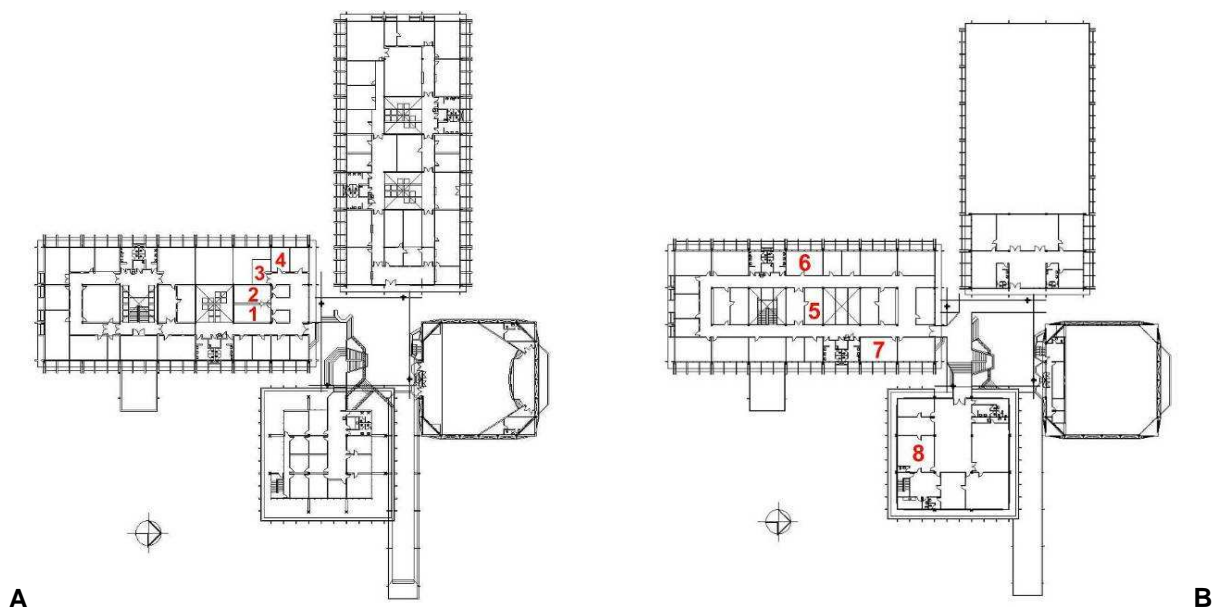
Localização dos HOBOS: A) Planta térreo; B) 1º pavtº.
